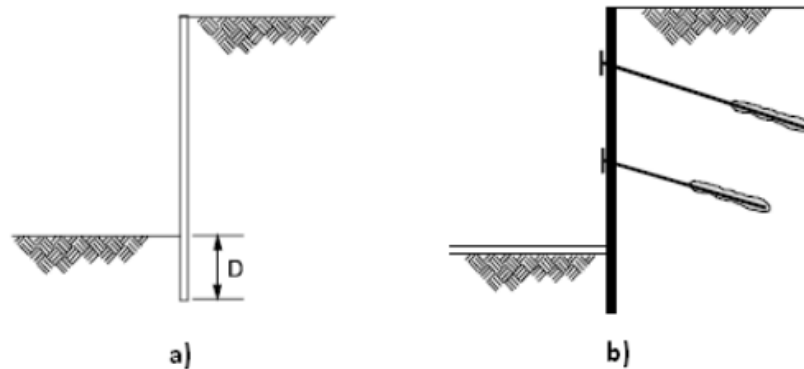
Clasificación de Muros Pantalla a) Muro Pantalla sin Apoyo, b) Muro Pantalla anclado o apoyado
